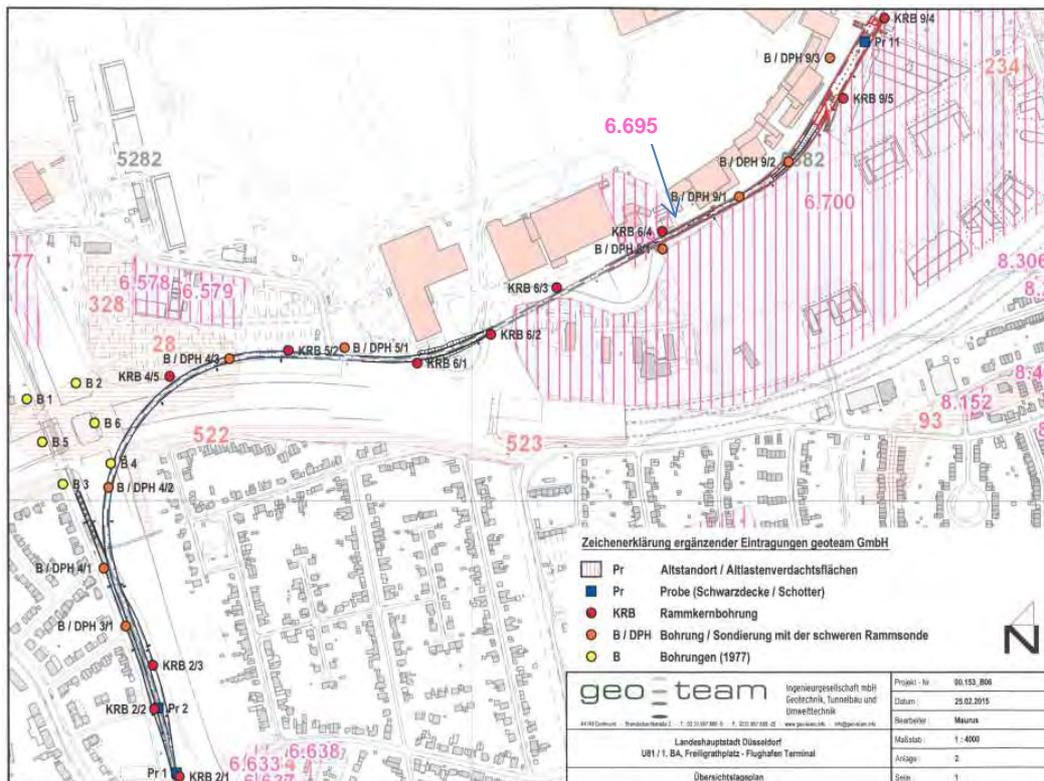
Lageplan Altablagerungen/Altstandorte in Bezug zur beantragten Maßnahme
